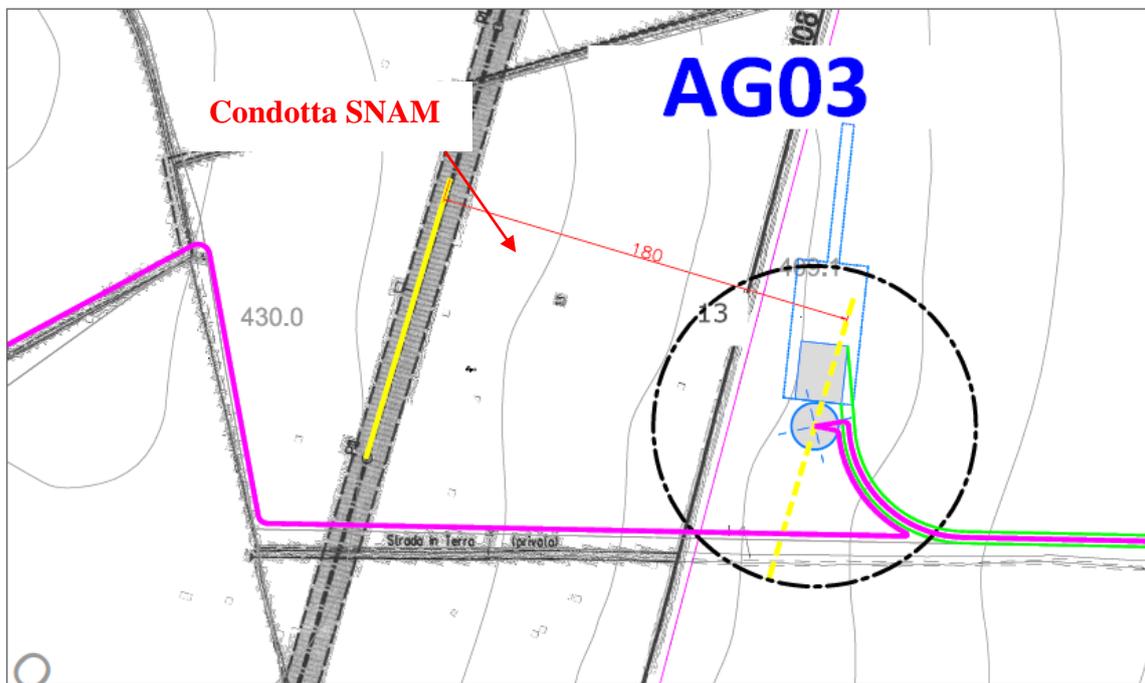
Nuova posizione AG3 e rispetto 180 m asse condotta SNAM SpA
